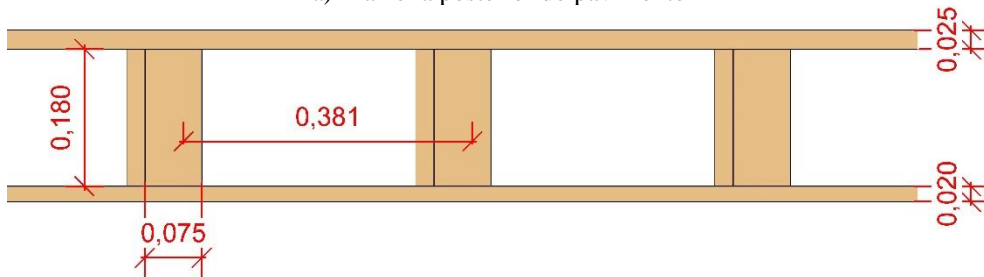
Detalhe da estrutura do pavimento do piso 2
